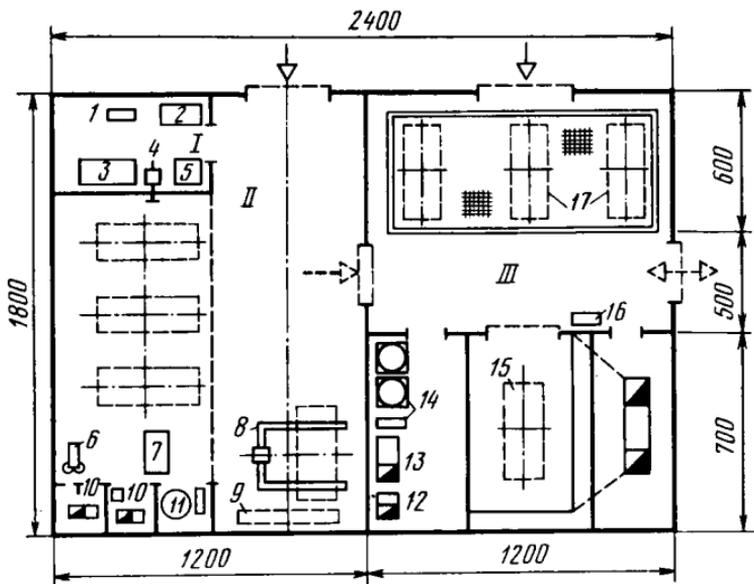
Планировка обойного (I), кузовного (II) и окрасочного (III) участков: 1 — швейная машина; 2 — стенд для обивки сидений; 3 — стол закройщика; 4 — верстак обойщика; 5 — стеллаж; 6 — точильный станок; 7 — установка для правки кузовов; 8 — опрокидыватель для легковых автомобилей; 9 — тележка для перевозки кузовов; 10 — столы газо- и электросварщика; 11 — сварочный трансформатор; 12 — краскочашка; 13 — стол для приготовления красок; 14 — шкафы для красок; 15 — камера для окраски и сушки автомобилей; 16 — пульт управления; 17 — посты подготовки к окраске
